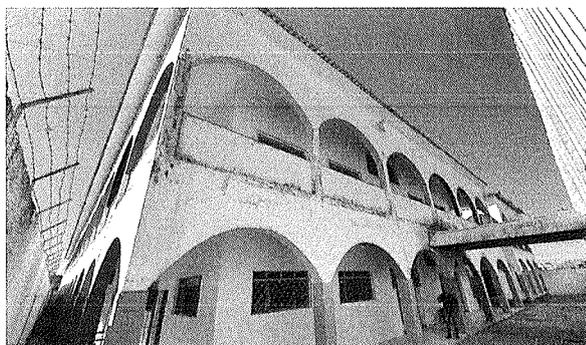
Infiltração e trincas em toda a edificação.
